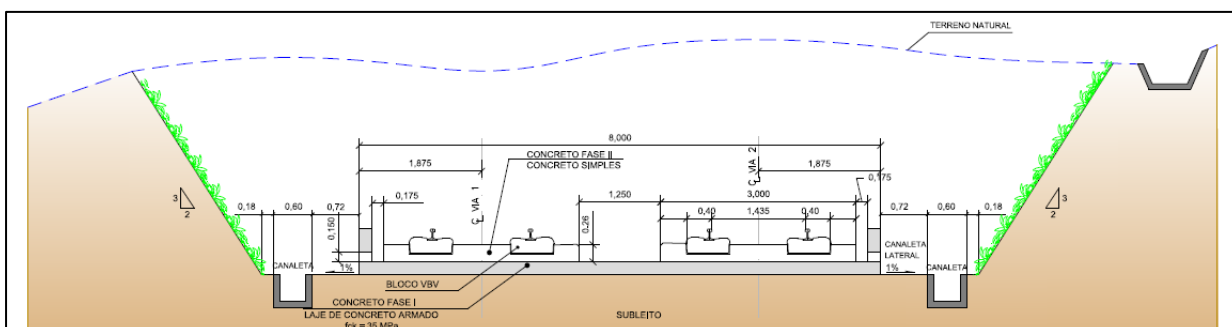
Seção transversal tipo – Detalhe Trecho em Corte Superestrutura LVT
